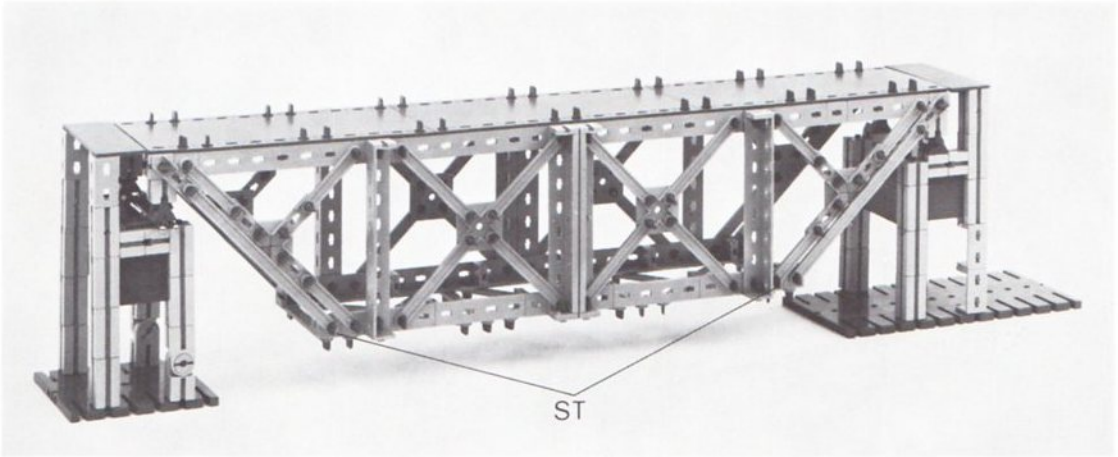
Modell einer Fachwerkbrücke mit „umgekehrter“ Anordnung der Gurte. Hier sind alle eingesetzten Bauelemente im Sinne der Statik „richtig“ verwendet. Der auf Zug beanspruchte Untergurt muß nicht unbedingt in Winkelprofilen ausgebildet sein. Das Modell ist ebenfalls mit einem u-t 1 und einem u-t S zu bauen. Rechts wieder das Fest-, links das Loslager.
